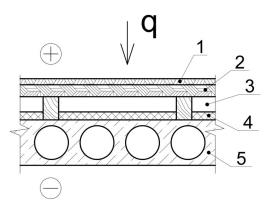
Схема конструкции полов на лагах: 1 – покрытие пола; 2 – древесноволокнистая плита; 3 – воздушная прослойка; 4 – экранная изоляция; 5 – железобетонная плита
